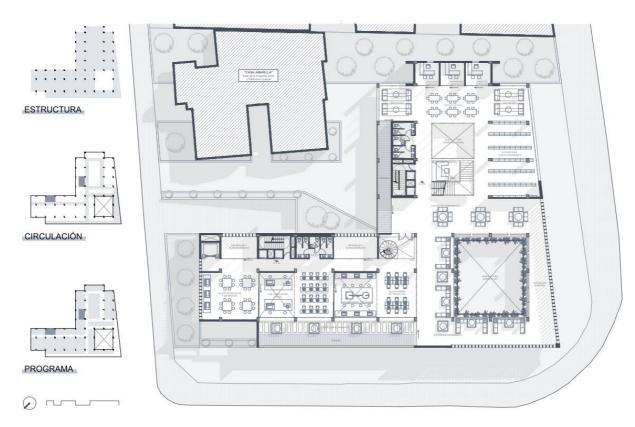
Planimetría: Planta Alta 1 (N+4,00)
